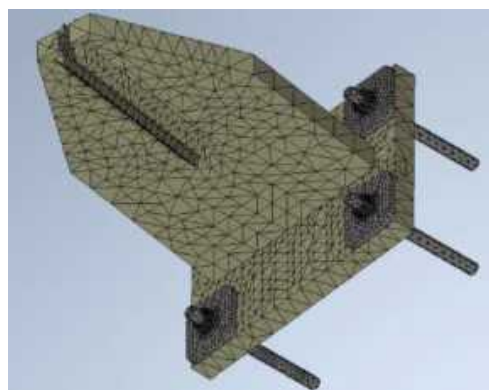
Detalhe isolado da malha da sapata e conexões metálicas.
